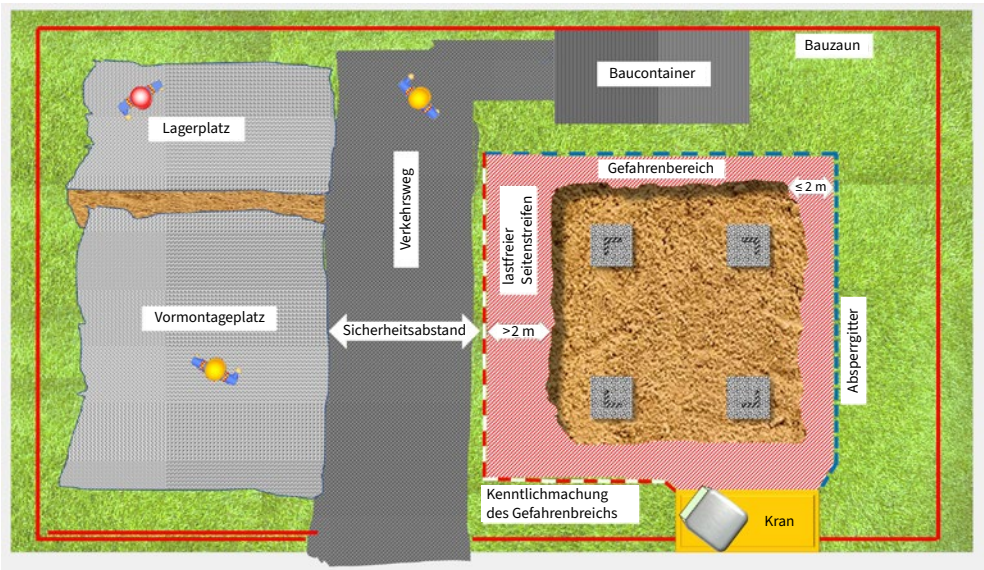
Beispielhafte Darstellung einer Baustelle zur Vormontage und zum Stocken von Freileitungsmasten. Nach Errichtung des Fußstuhls wird die Baugrube i. d. R. verfüllt. Zum Ende des Arbeitstages kann der Bauzaun geschlossen werden.
